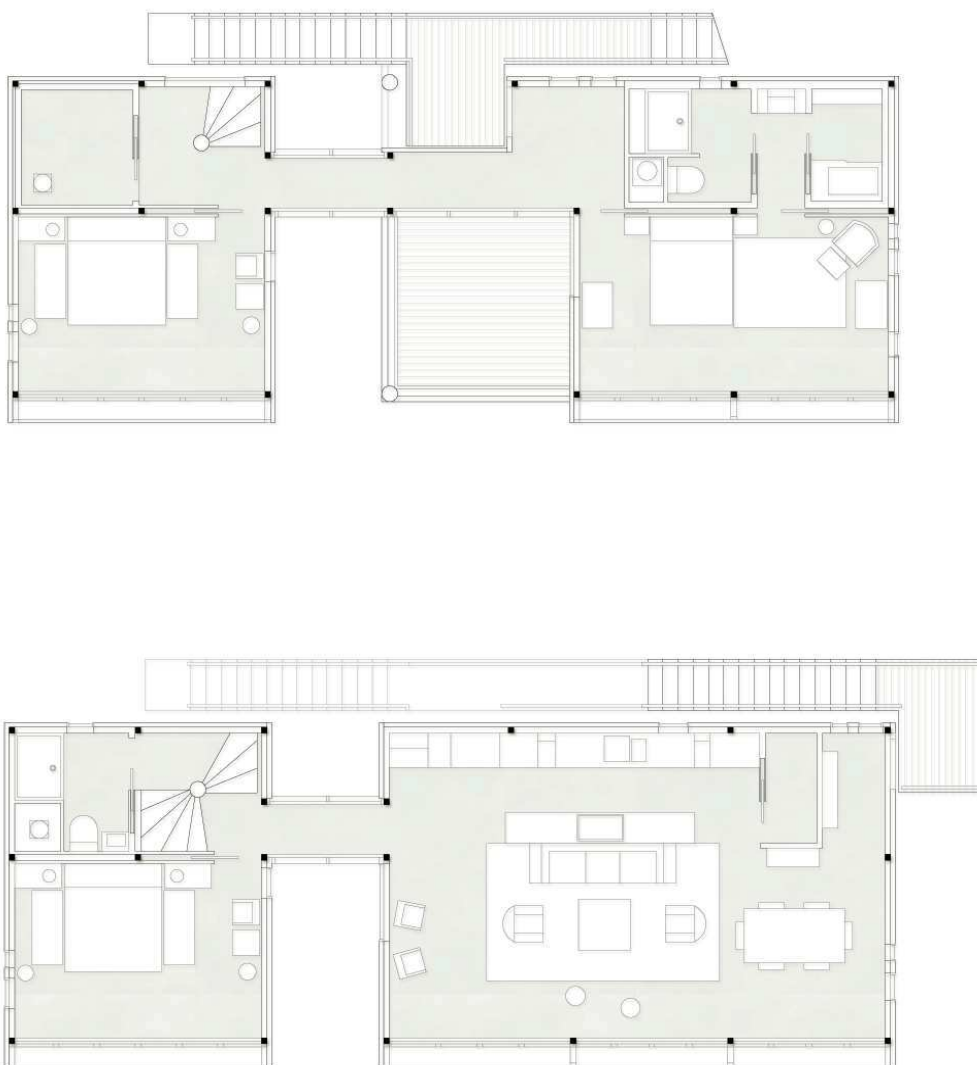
Figura de autor. Planta baja y primera casa Loblolly House.
